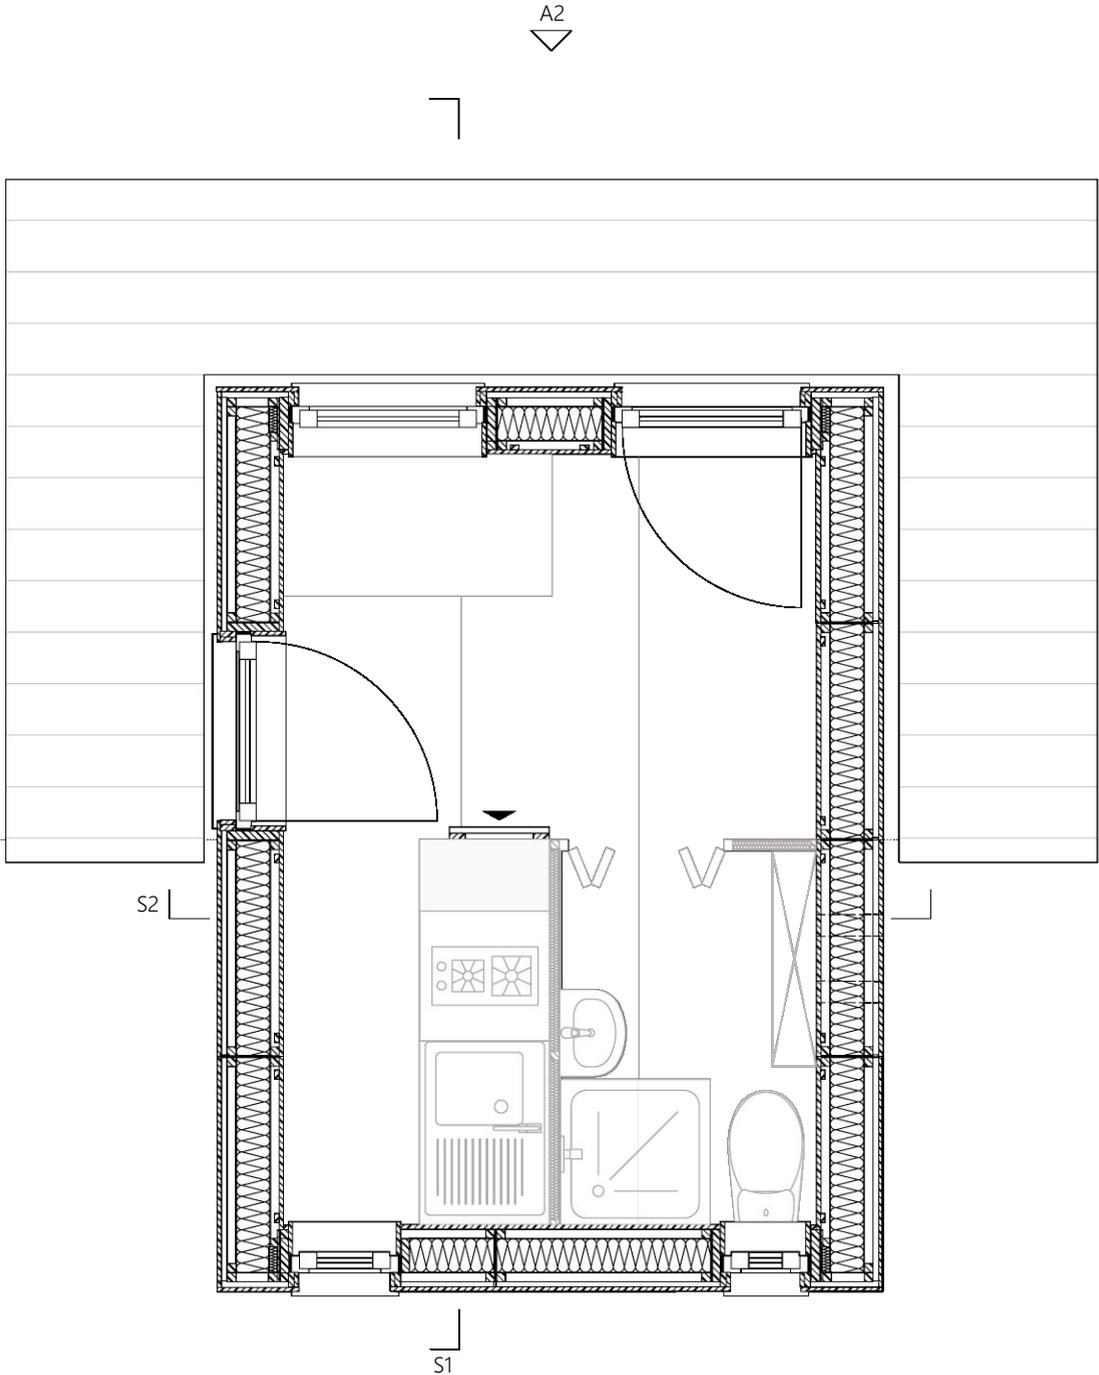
Entwurf Grundriss, Maßstab 1:35
